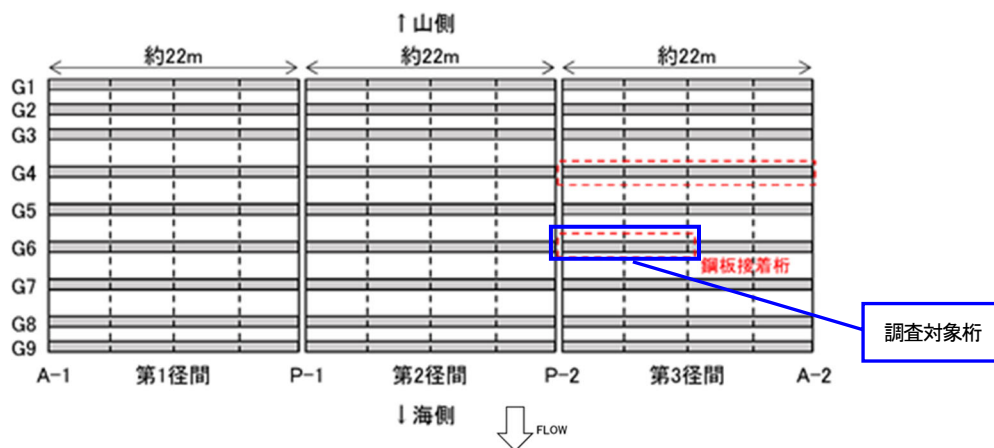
橋梁一般図と調査位置 (単位 : mm)
